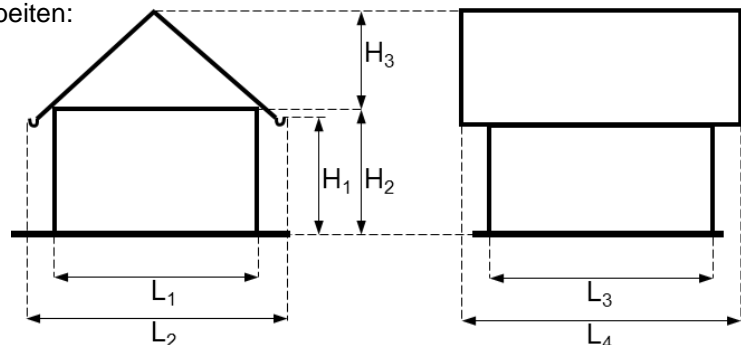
Einrüstung mit Standgerüst (Fassadengerüst), Aufmaß bestimmt durch eingerüstete Fläche
